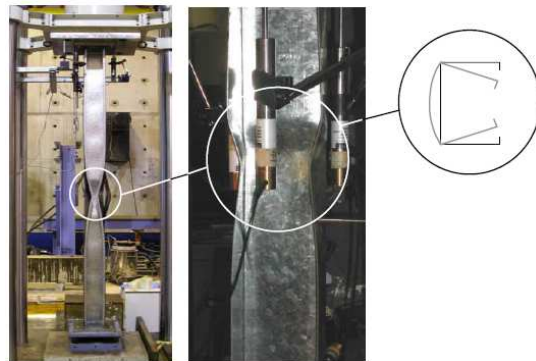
Fenómenos de instabilidade local, (Silvestre & Camotim, 2006).
